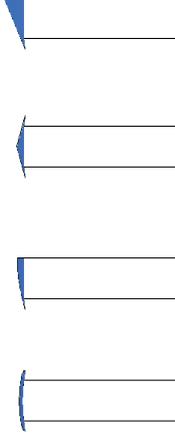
Propostas para acabamentos na região superior da platibanda, muros e muretas.
